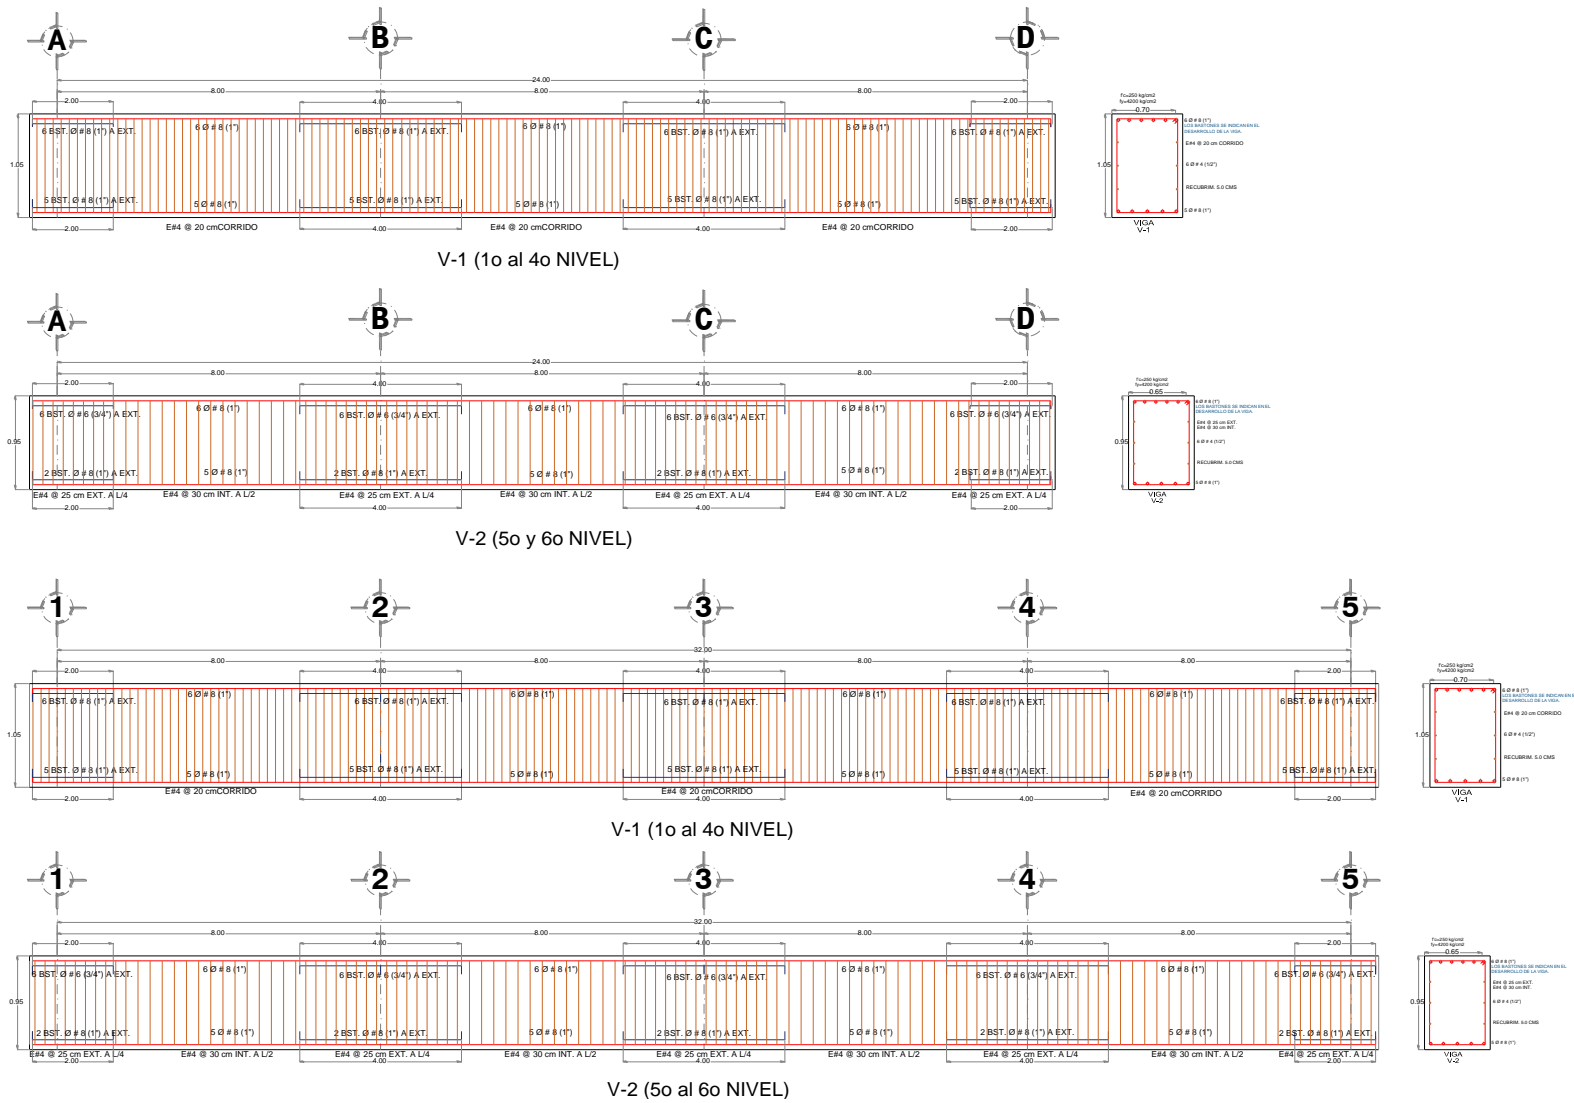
Detallado de armado de vigas de edificio de 9 niveles con base a la hipótesis de las NTCC-17.
